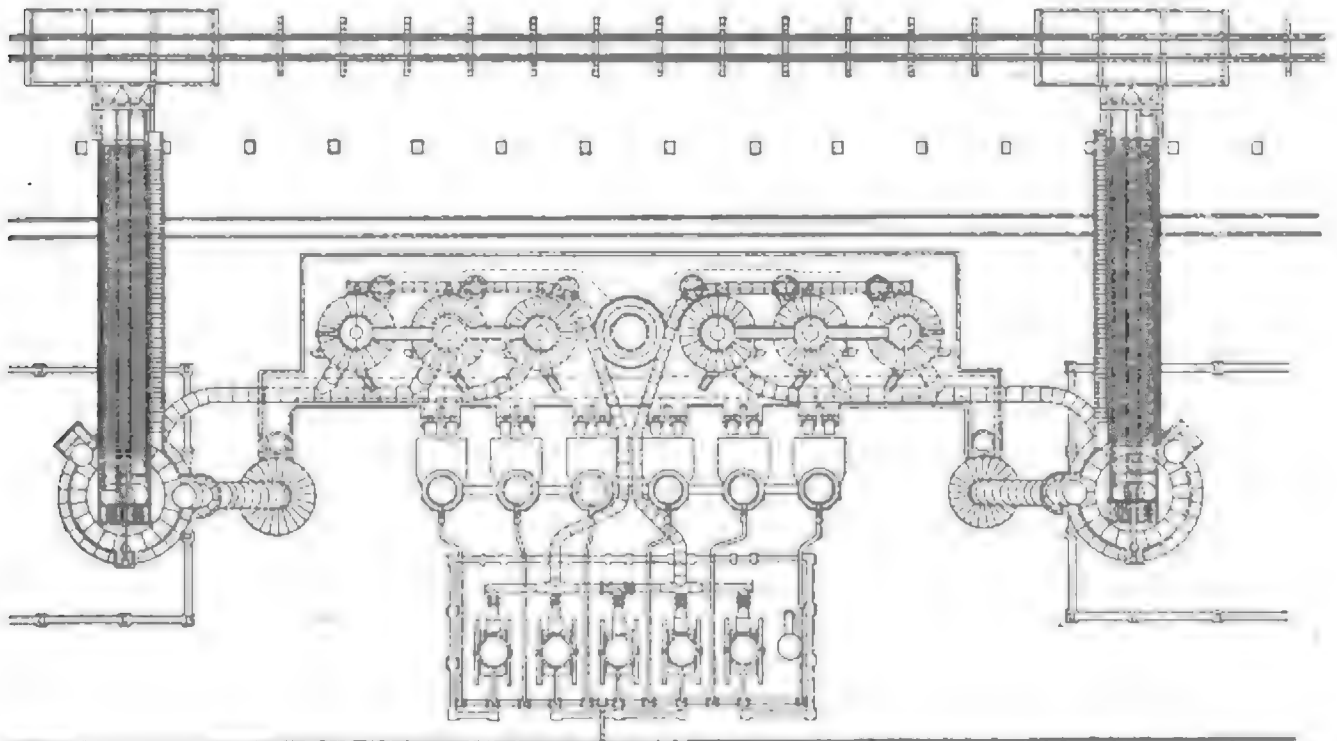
Lageplan der neuen Hochofenanlage in Columbus, Ohio.
